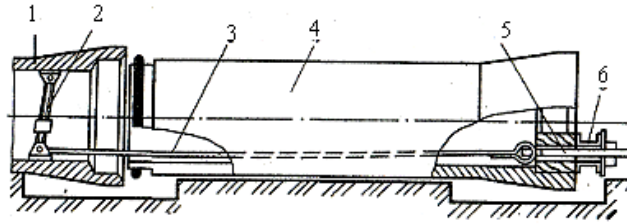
Îmbinarea tuburilor cu ajutorul dispozitivului de întindere amplasat în interiorul tubului în montare. 1 – tubul montat; 2 – distanțier cu filet; 3 – dispozitiv de întindere; 4 – tubul în montare; 5 – șuruburi de întindere; 6 – grindă de reazem
